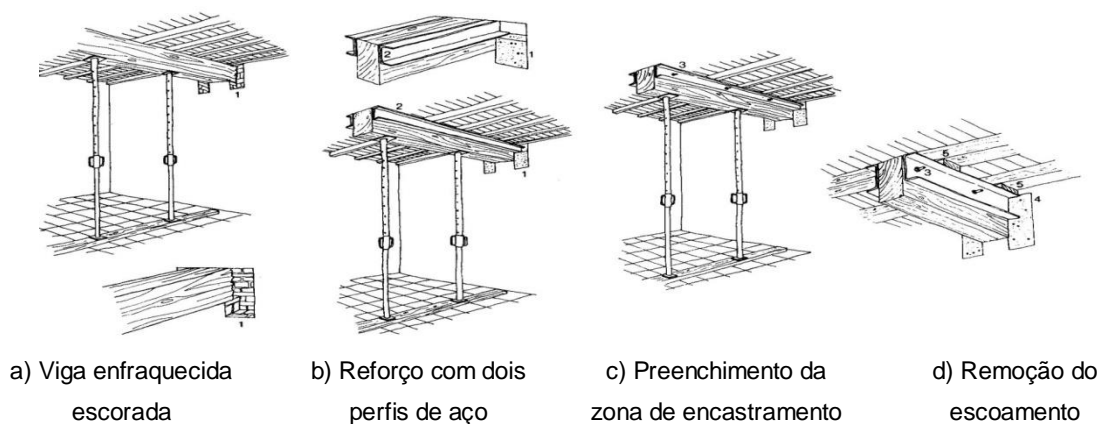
Reforço de viga de madeira com um perfil de aço laminado, fases de execução
